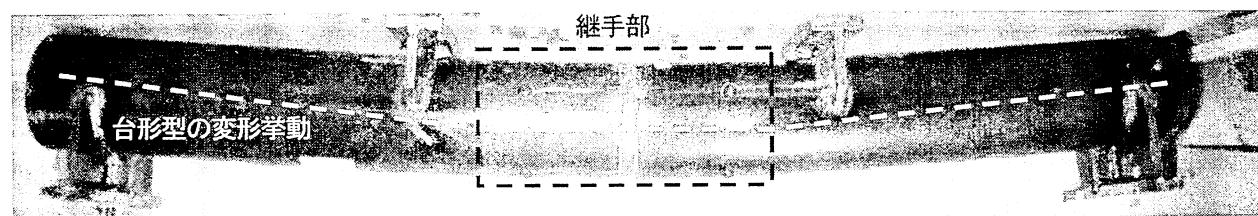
試験後の供試体変形状況 (ワンタッチ継手)
